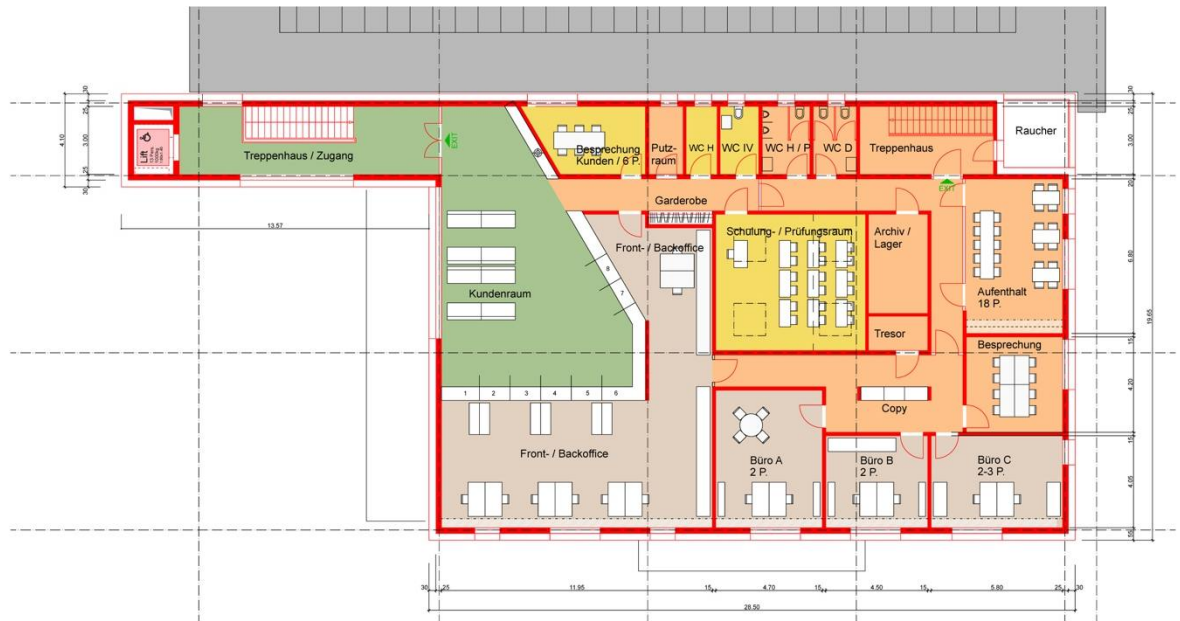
Aufstockung TO 4, MFK Verwaltung; Grundrisslayout, Obergeschoss
